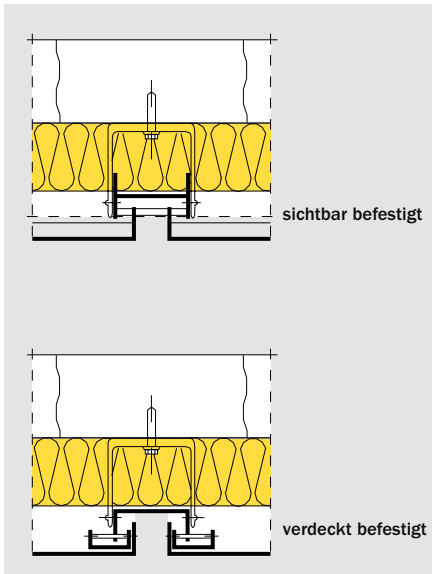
Aluminium-Kassetten mit hängender Befestigung
